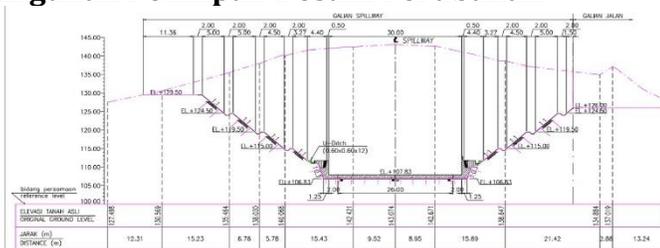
Cross Section Desain Dinding bangunan Pelimpah.
